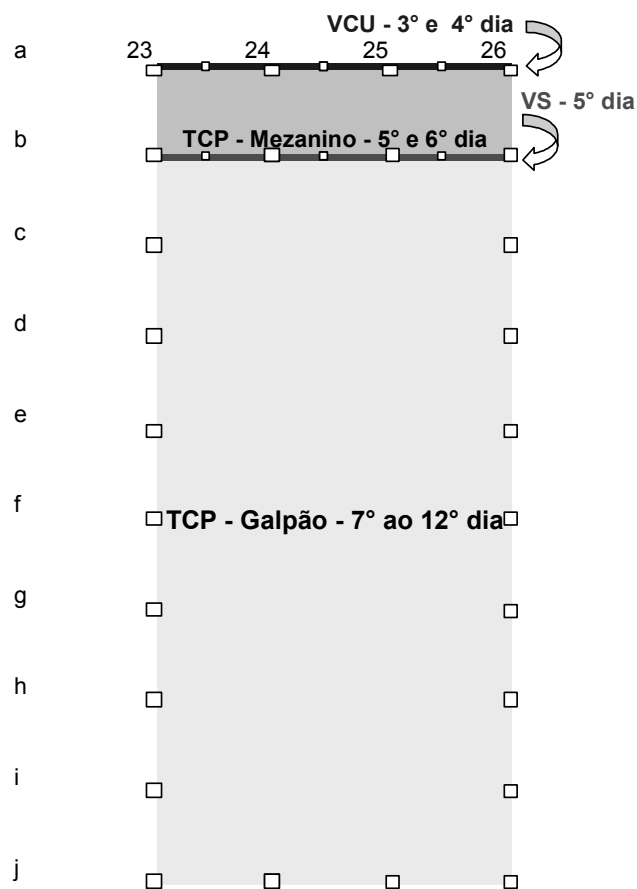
Plano de seqüenciamento da cobertura (vigas e telhas) – Etapa 3
